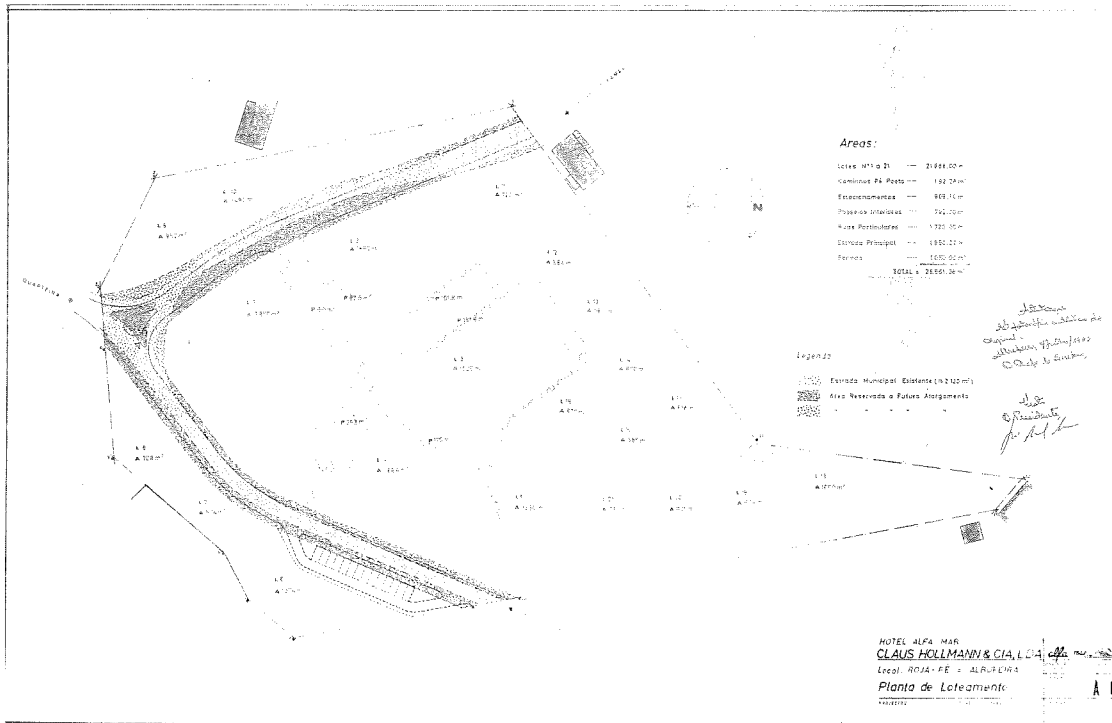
Planta do Alvará de Loteamento 9/82 – sem escala
